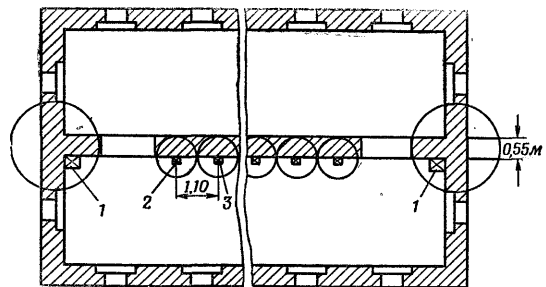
Повреждение здания подрыванием внутренней капитальной стены:
